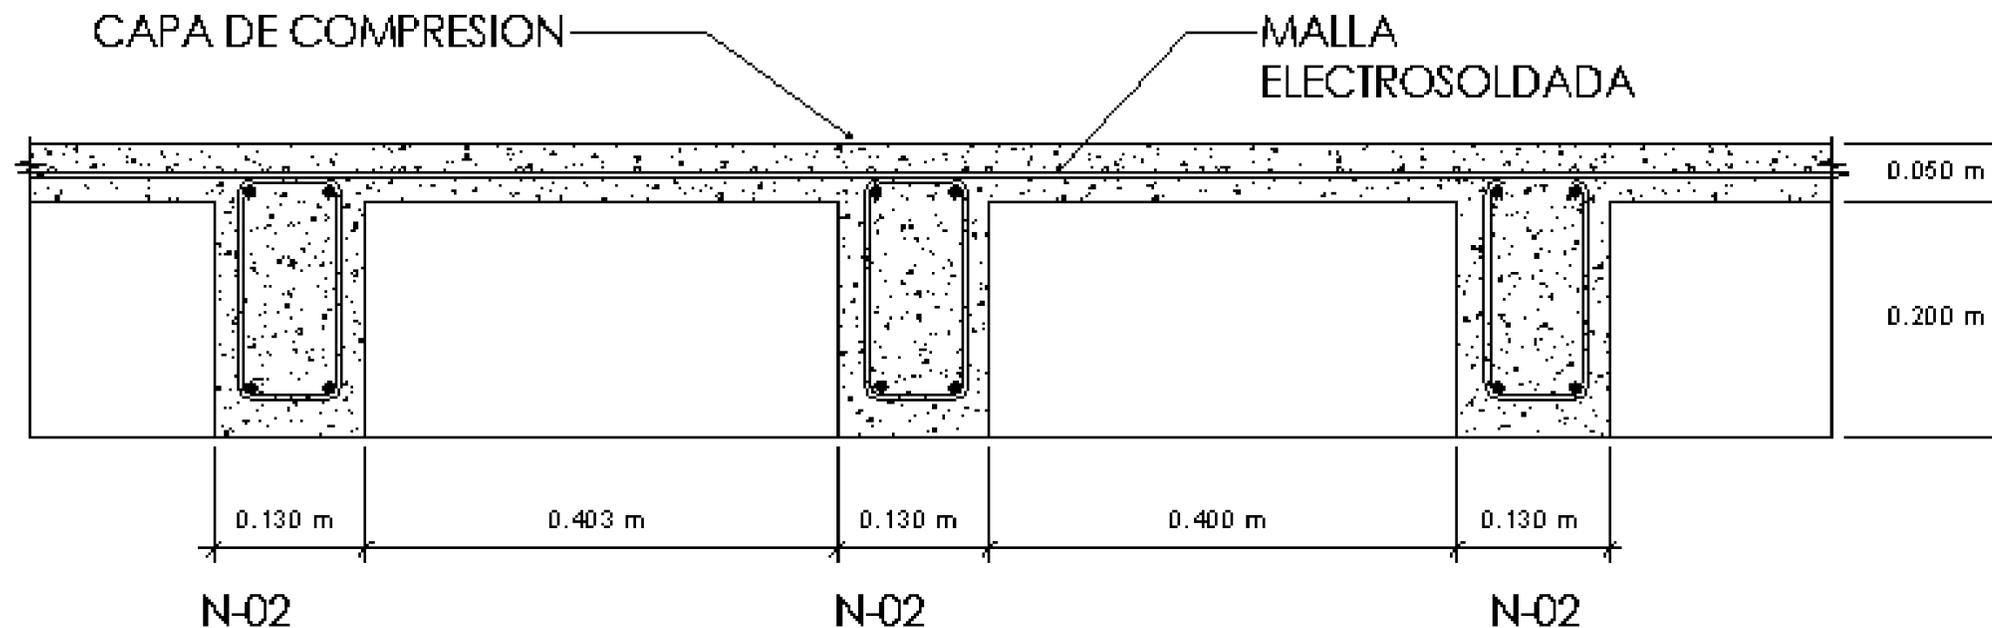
Detalle de losa reticular. Fuente elaboración propia
